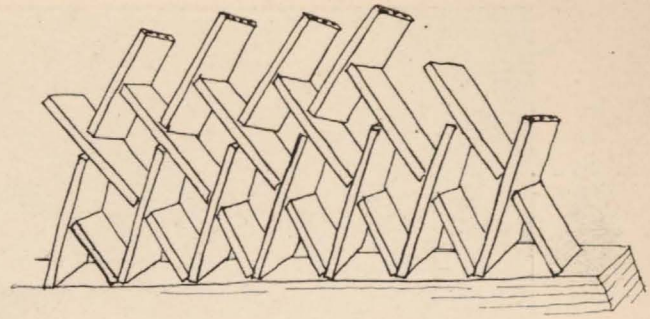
Bóveda reticulada de hormigón armado, construida en un hangar italiano.
